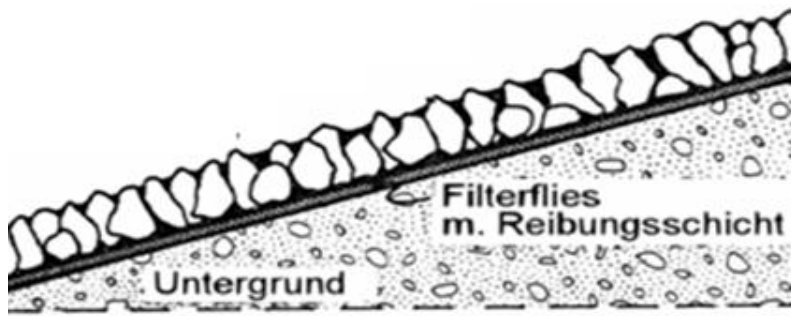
Deckwerk aus Schütt- oder Setzsteinen mit Verguss (Asphalt oder Beton) [44]
